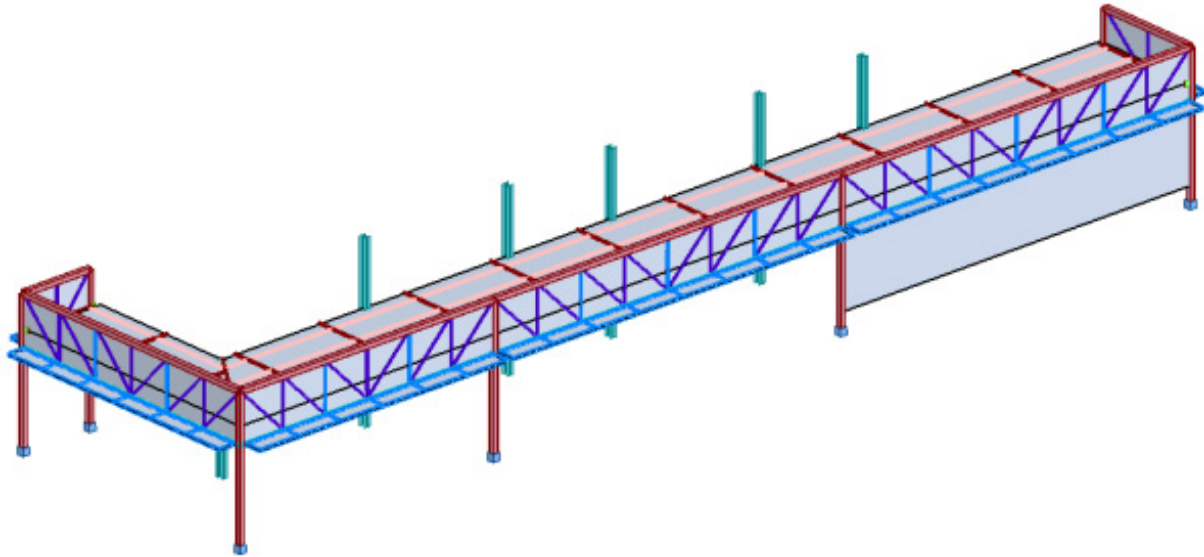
Modelo de cálculo da estrutura metálica da zona frontal do edifício.
